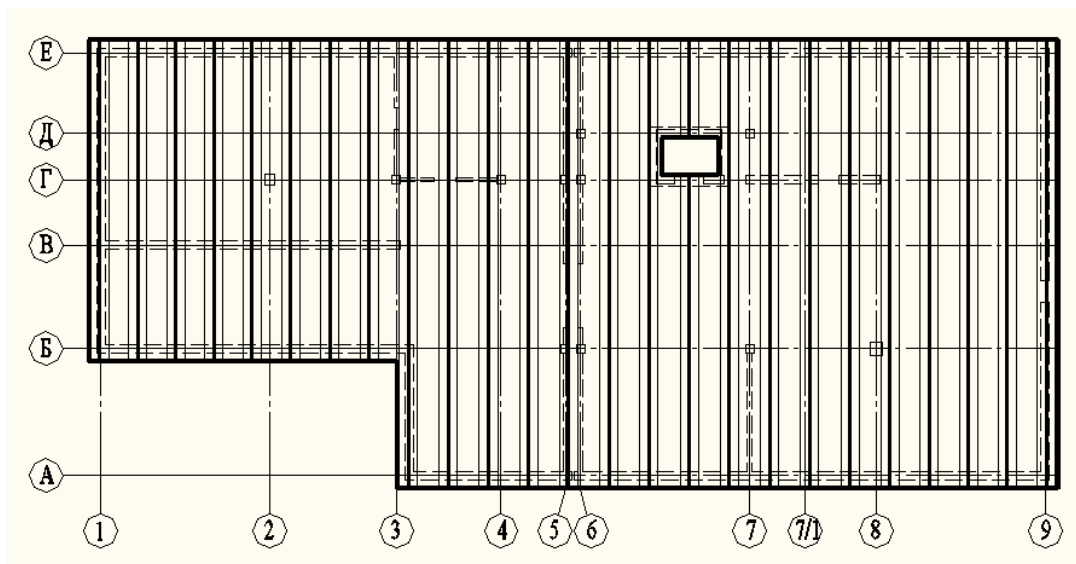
Схема расположения поддерживающих каркасов в фундаментной плите
